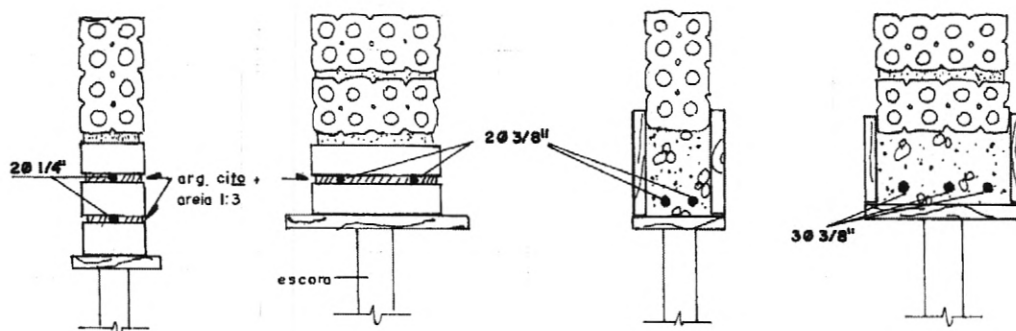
Vergas em alvenaria de tijolo furado para vãos até 1,00m e entre 1,00m e 2,00m
